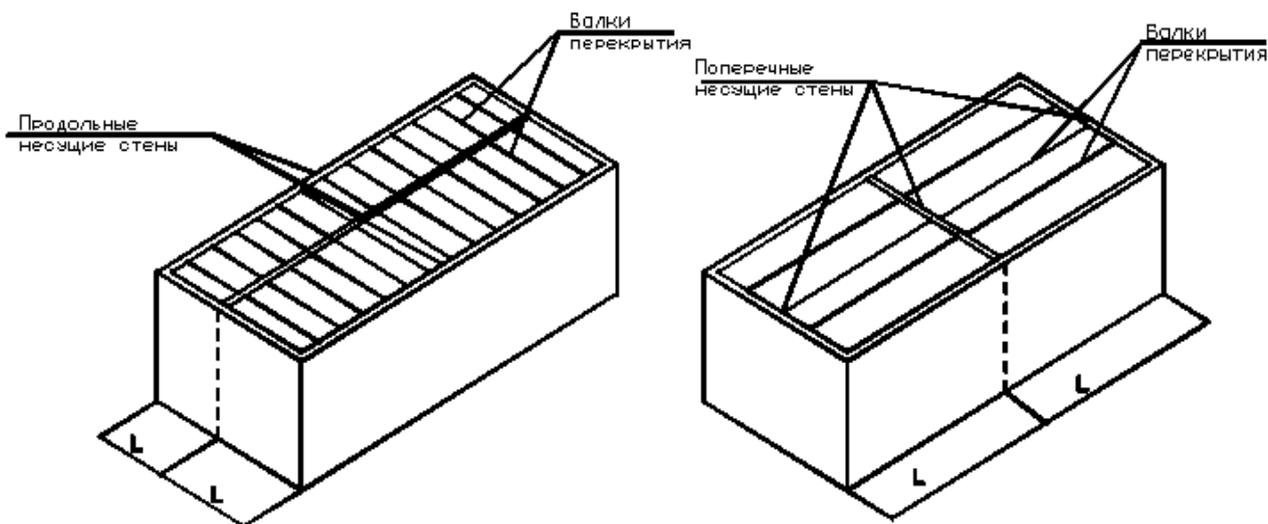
Здания с продольными и поперечными несущими стенами
